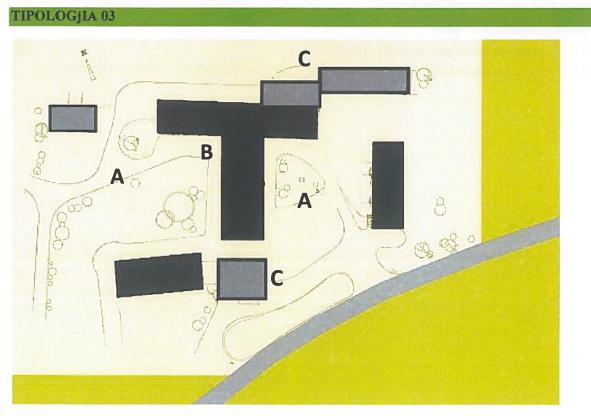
Zonat bujqesore B, tipologjia 3 Planimetria e përgjithshme
